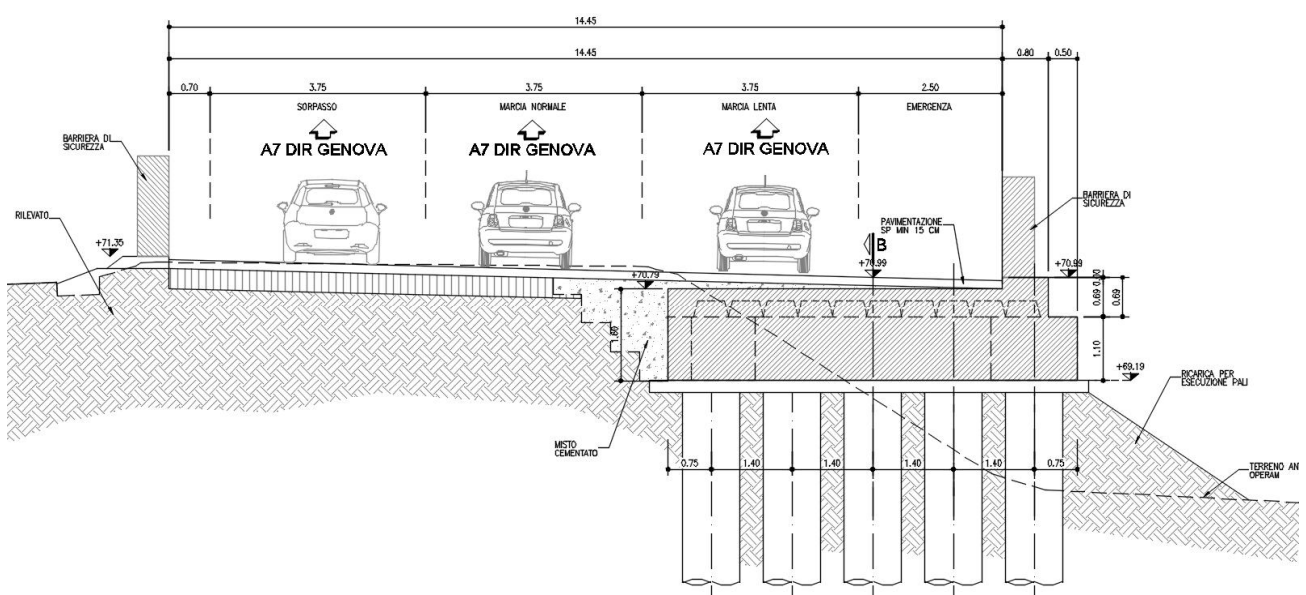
Spalla lato Genova - Sezione trasversale zona impalcato
